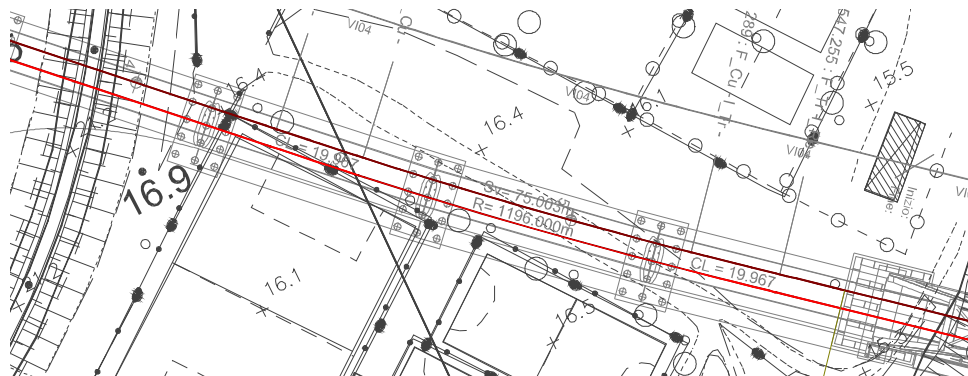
Pianta fondazioni - Ponte a struttura mista acciaio calcestruzzo a doppio binario - Pile in alveo
